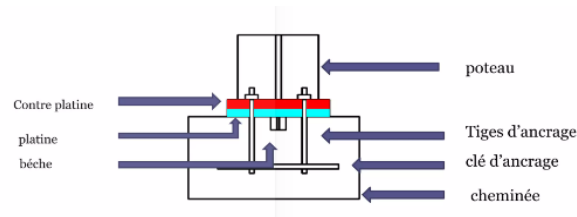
pied de poteau articulé à la fondation par une platine et contre platine
